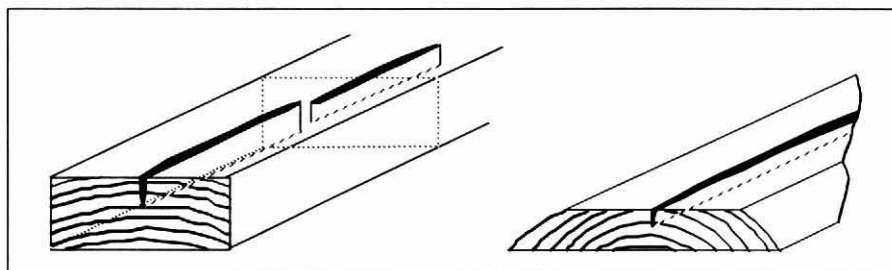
GRIETAS EN EL CENTRO DE LA PIEZA
